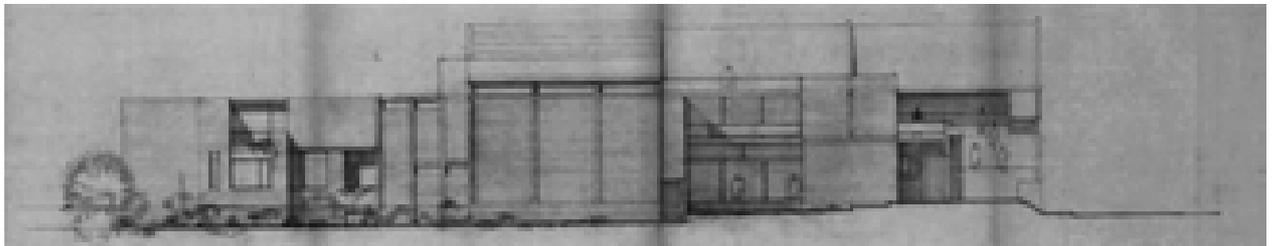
Prospetto Est, stato futuro– 15/01/1977 (AABS-1996.701)
